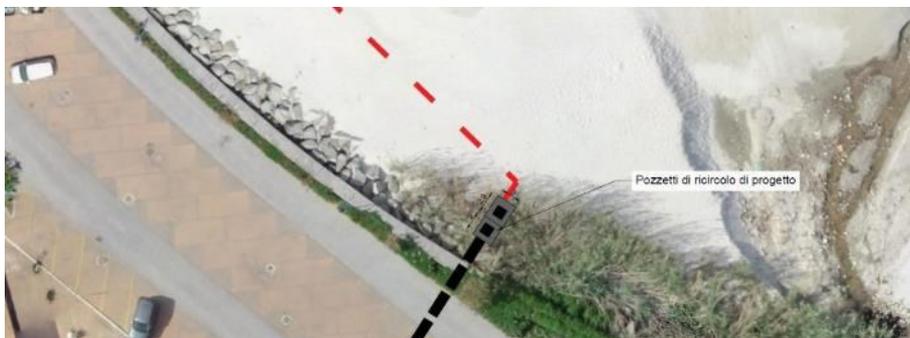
Ubicazione planimetrica dei pozzetti di ricircolo.
